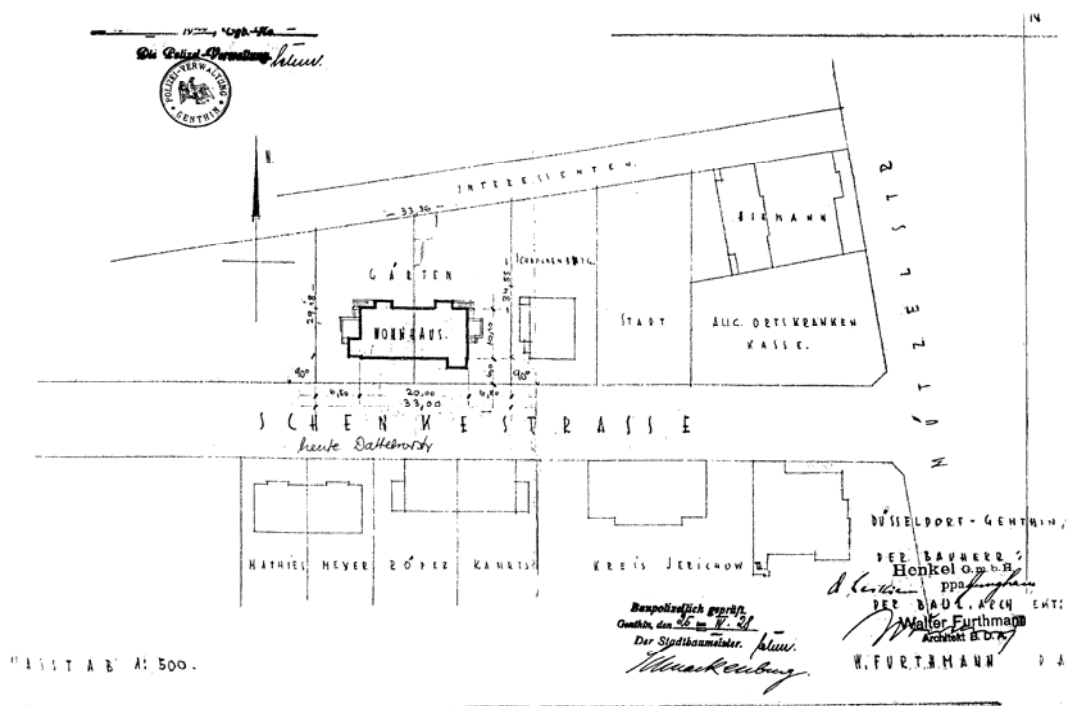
Genthin – Lageplan/ehem. Schenkestraße (heute Dattelner Straße)
